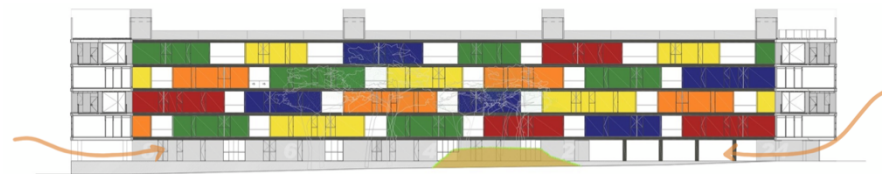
Sección longitudinal, planta baja libre en los laterales pequeños.
